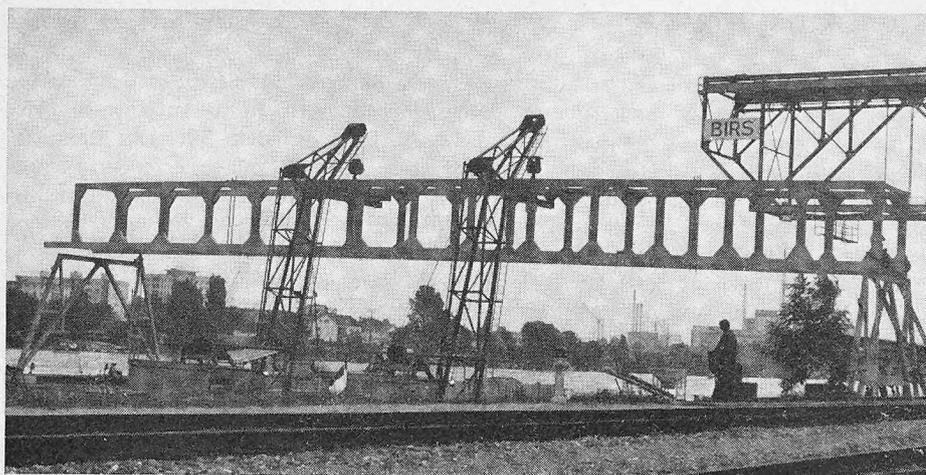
Mit einem präzisen Einschwimmmanöver wurde es möglich, die Brücke in zwei Stunden auf die vorbereiteten Auflagerjoche zu montieren. Schutzwanne, Rohrleitungen, Laufsteg, Aufstiegstreppen, die Kabine für den Leitstand und die Elektroinstallationen konnten anschliessend von den jeweiligen Unternehmern gefahrlos und ohne Beeinträchtigung des Schiffs- und Verladebetriebes ausgeführt werden
